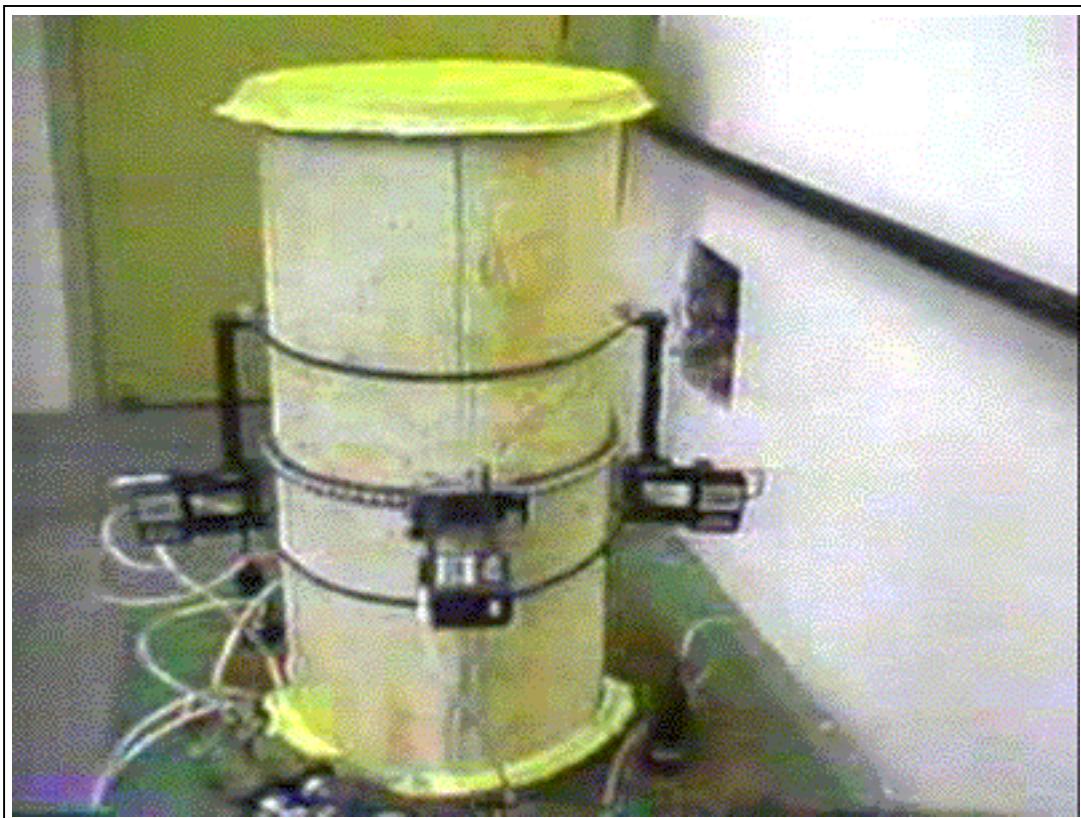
Detalhe 3 dos extensômetros utilizados nos CP's de concreto
